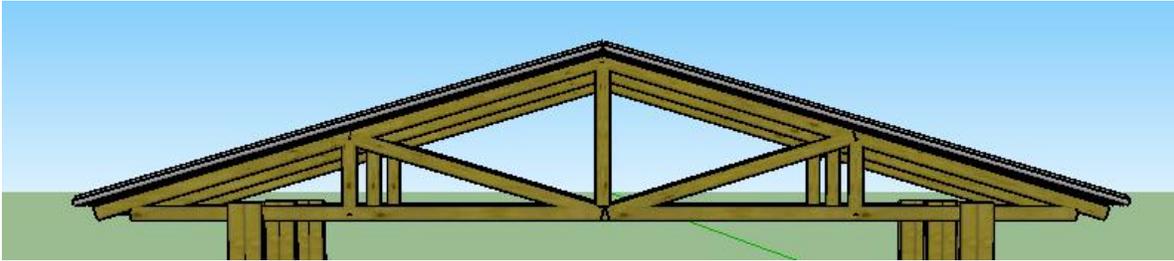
VISTA CUBIERTA.FUENTE: PROPIA
